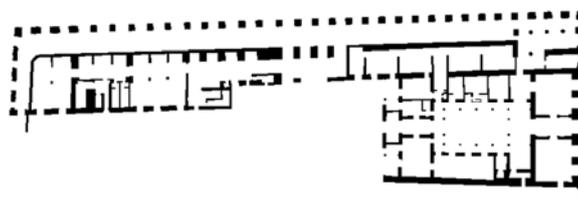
Planta baja del edificio después de 1960 (Corradine).
